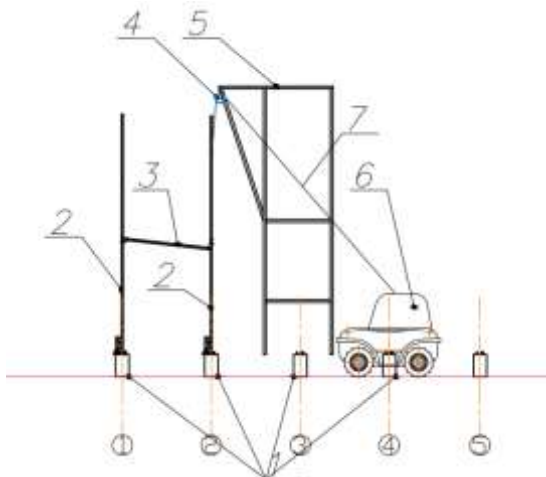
Принципова схема монтажу теплиці: 1 – мікропальові фундаменти із спеціальним поворотним кондуктором; 2 – стійки (колони) теплиці; 3 – в'язі; 4 – монтажний блок; 5 – монтажна вежа; 6 – базова універсальна машина; 7 – монтажний трос
